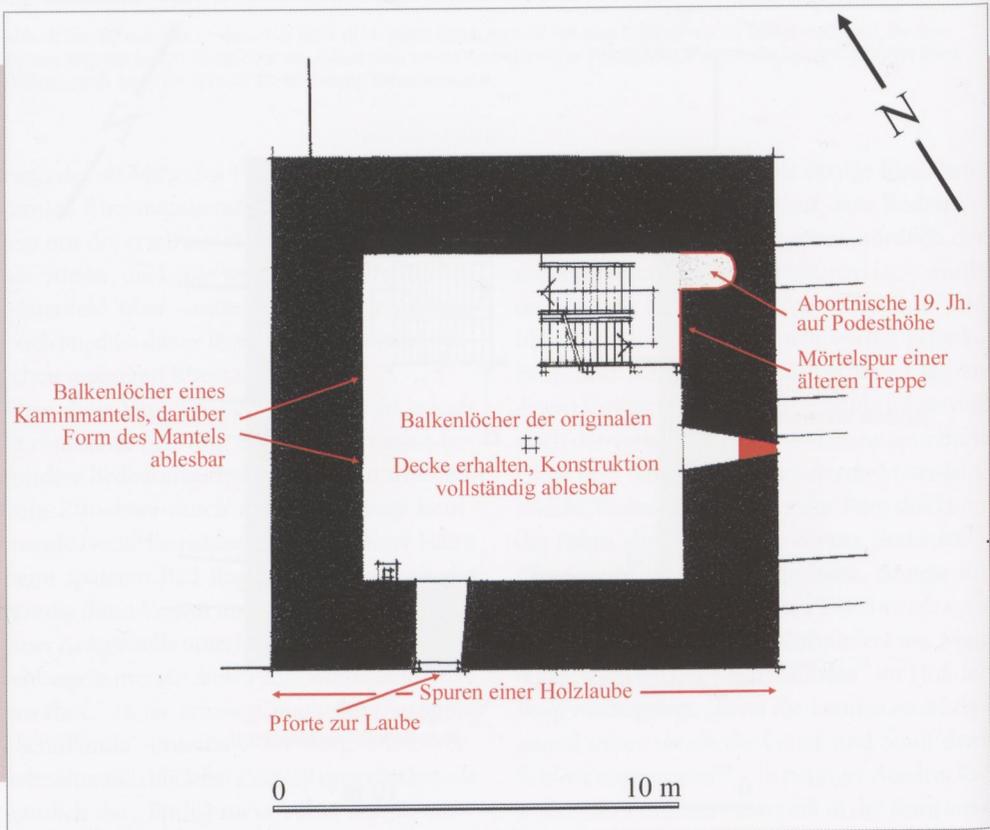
Maienfeld, der Wohnturm, Grundriss des 4. Geschosses mit Hinweisen auf mittelalterliche (und jüngere) Befunde in rot (Th. BILLER, Grundlage wie Abb. 5).
